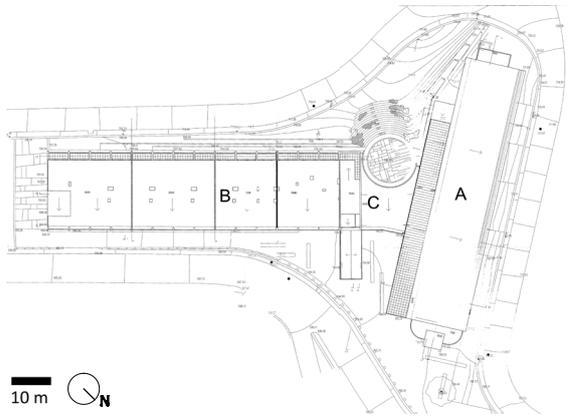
Residência Pedro Álvares Cabral - Complexo fabril João Roque Cabral: planta de cobertura.
